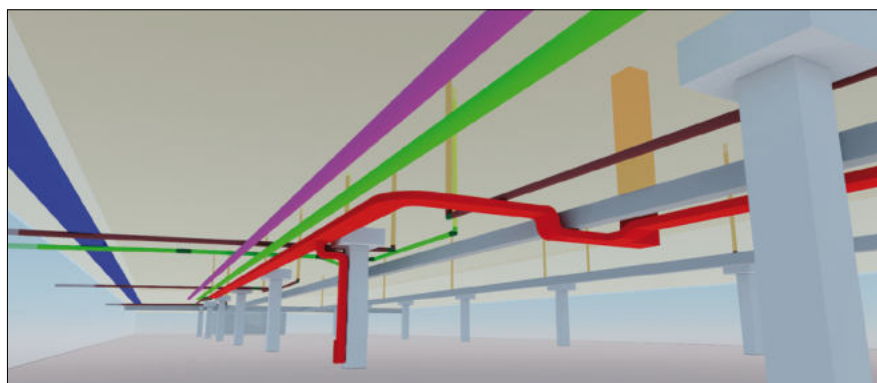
Instalacja wentylacji mechanicznej zamodelowana w programie ArCADia BIM i dopasowana do zaprojektowanego układu sufitów podwieszanych
